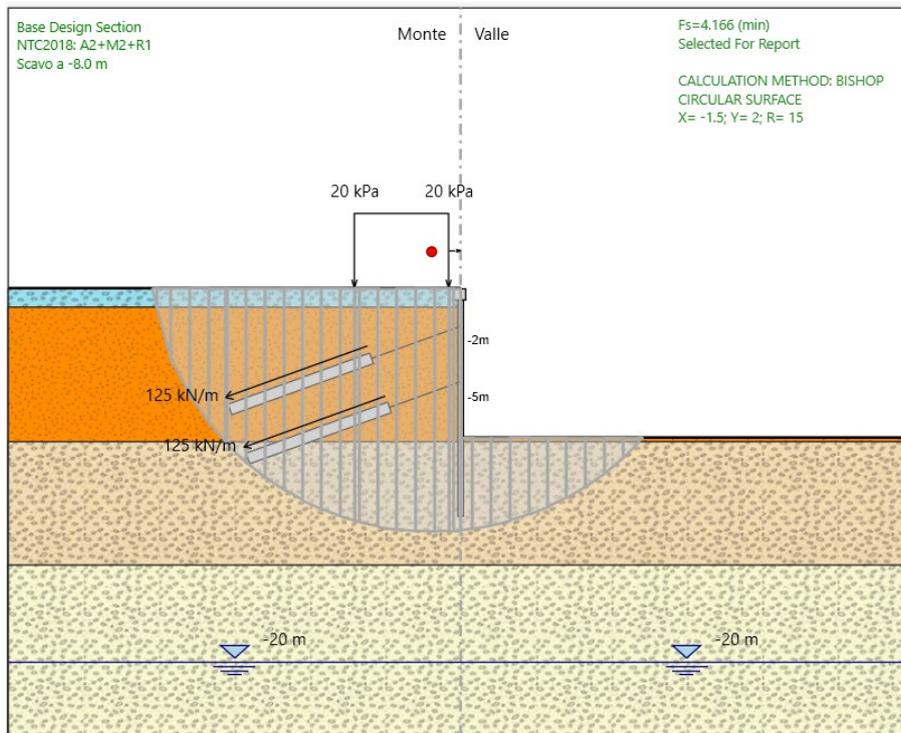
Sezione Tipo C - Condizioni statiche (FS=4.2)
